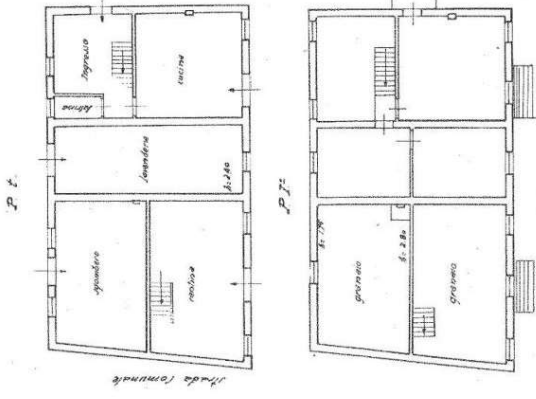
Fabbricato Part. 49. Planimetrie Piano Terra e Piano Primo
